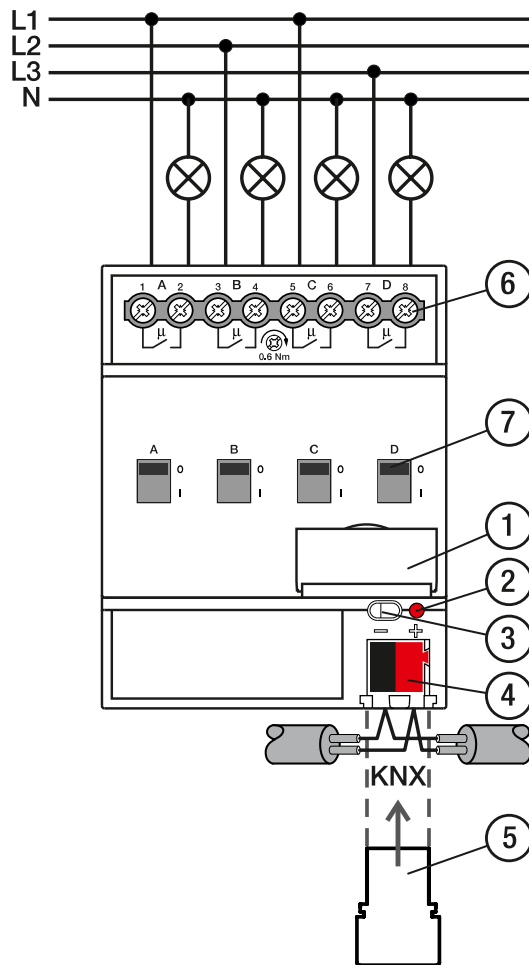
Schema di collegamento SA/S 4.x.x.2
